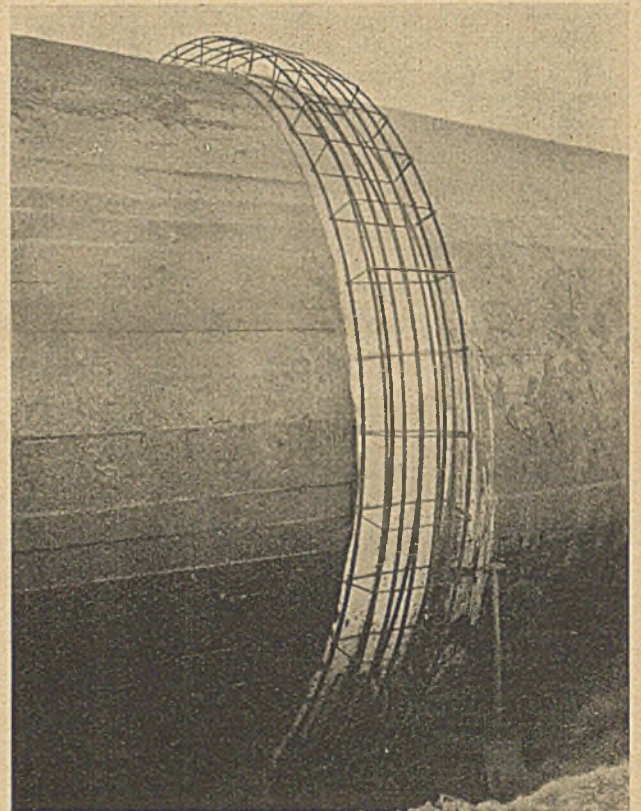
Eisenbewehrung einer Rohrmuffe.
